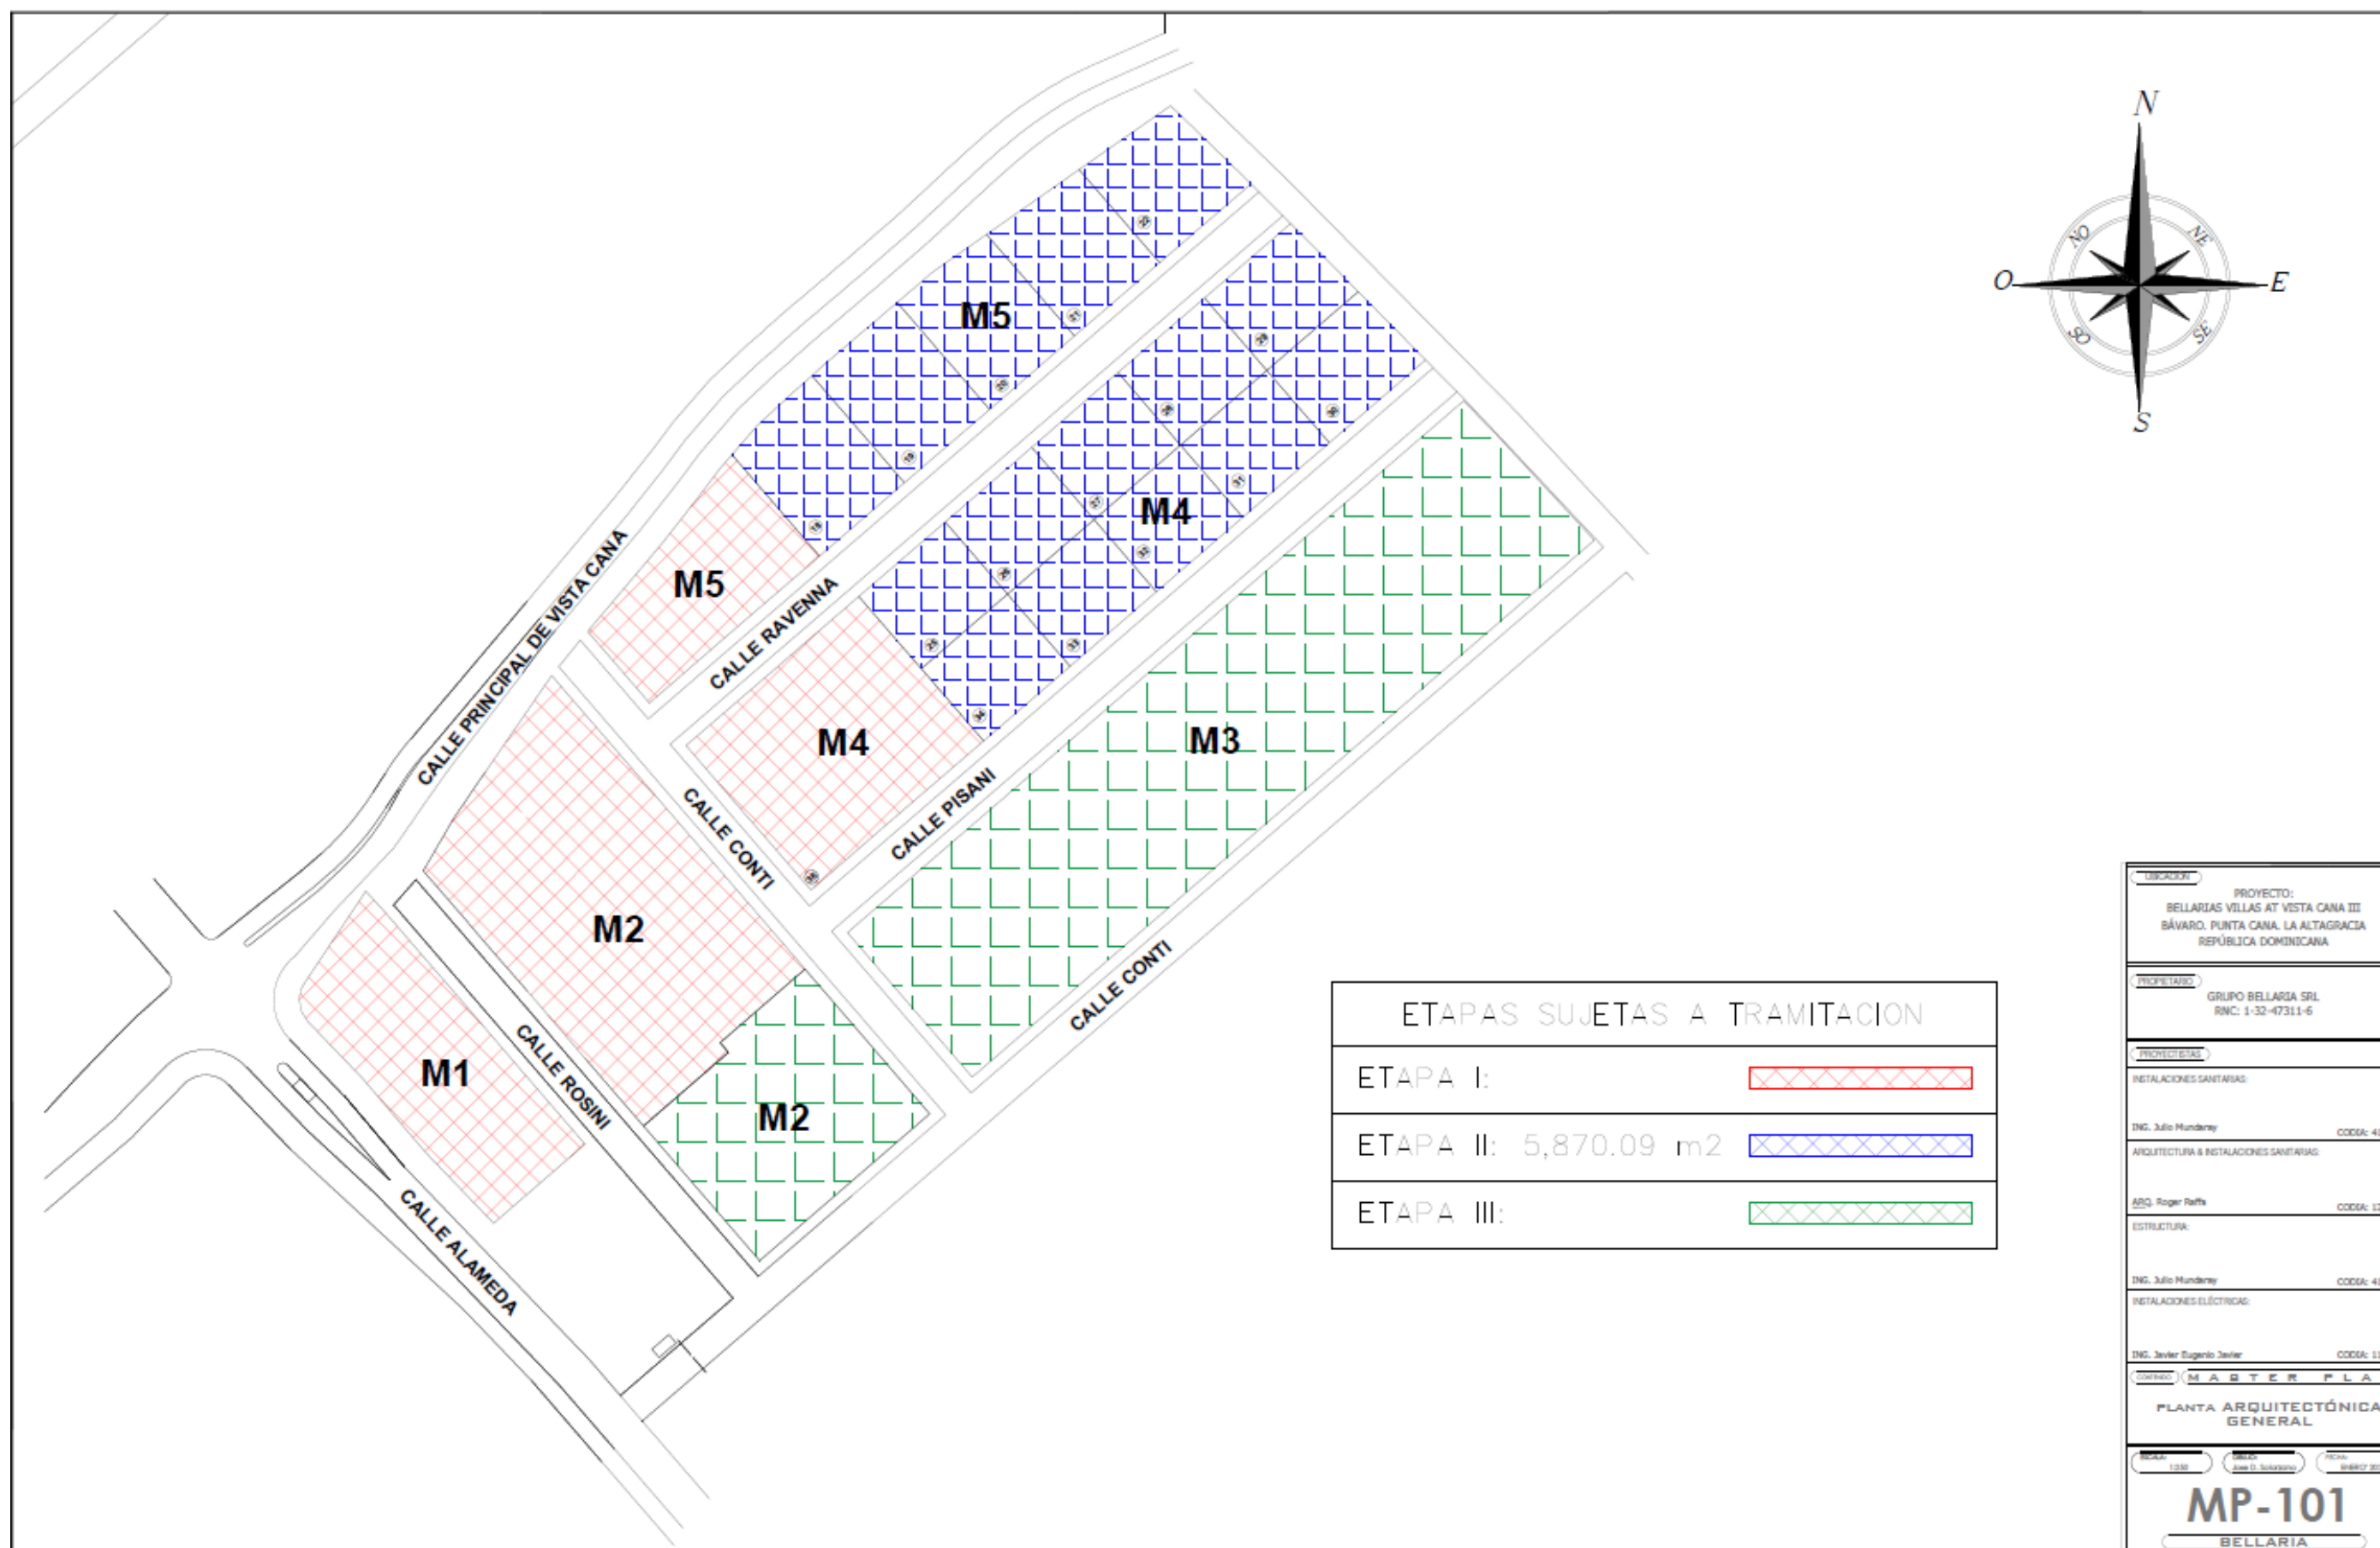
Plano de conjunto general, con las 3 etapas del proyecto Bellarias Villas at Vista Cana.
